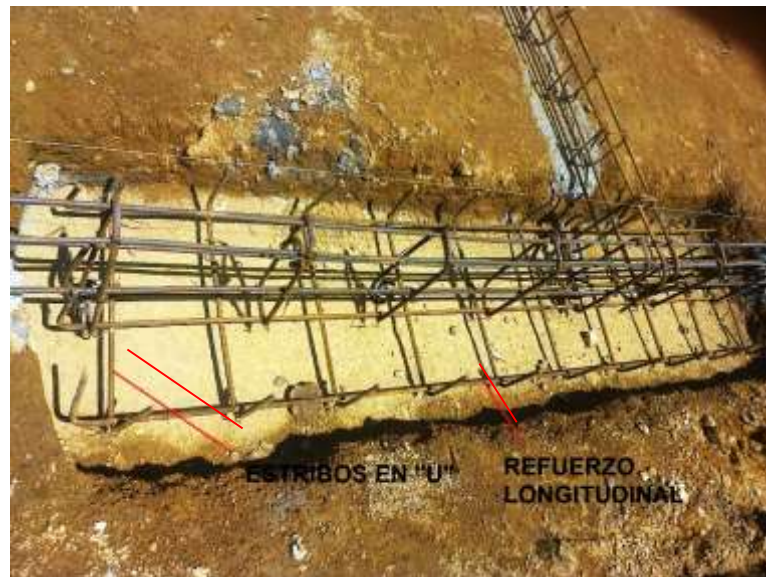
Estribos y varillas longitudinales – Zapata.
